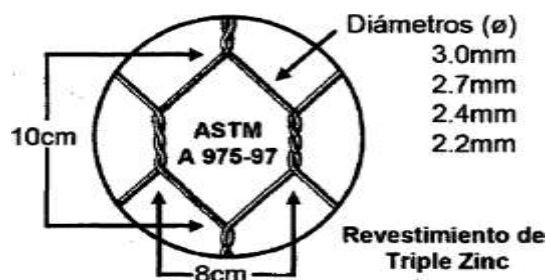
Gavión tipo caja o colchón antisocavante galvanizado
